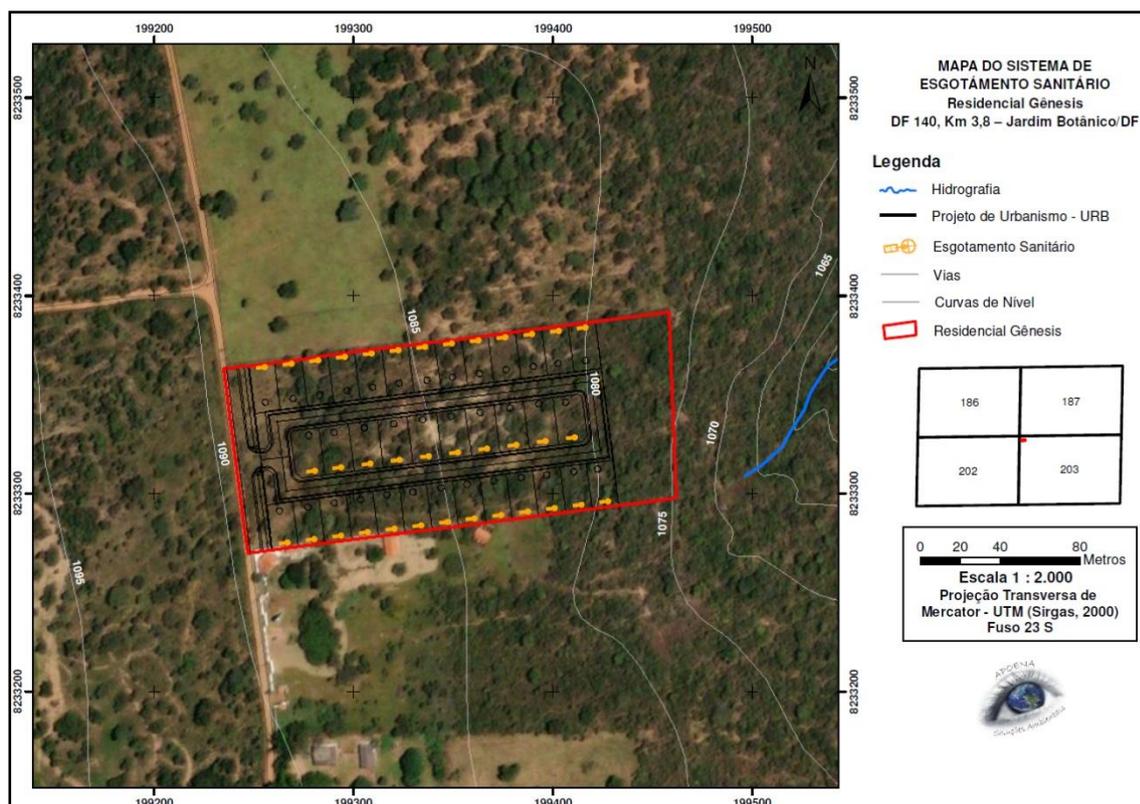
Croqui do sistema de esgotamento sanitário proposto.
